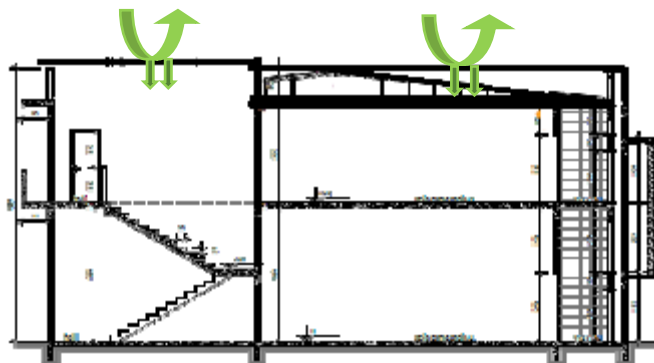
Reflexão do Telhado - Edifício Proposto.
